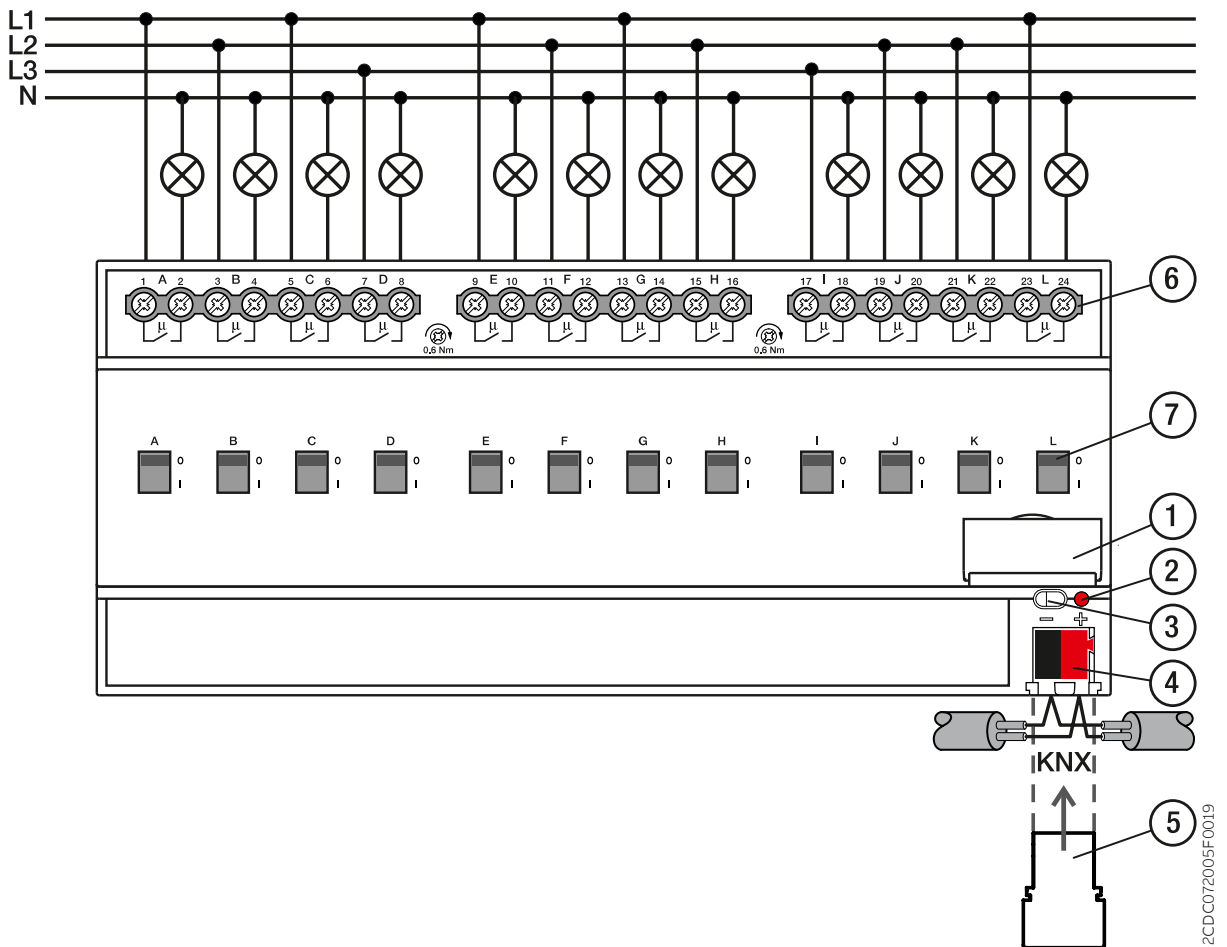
Schema di collegamento SA/S 12.x.x.2
